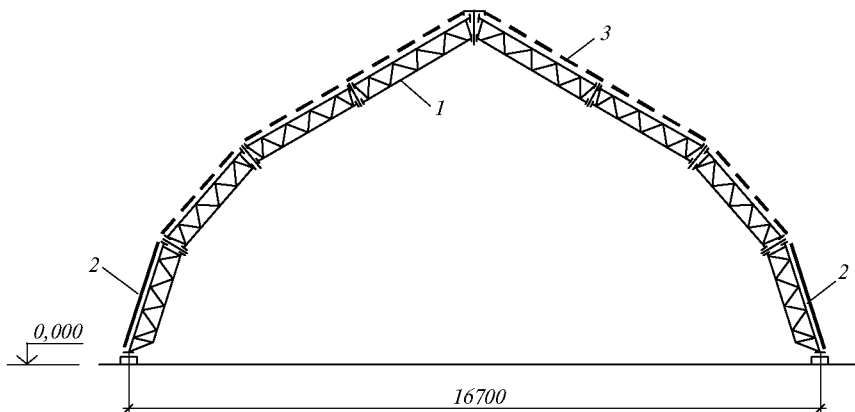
Поперечный разрез арочного здания с тентовым покрытием
